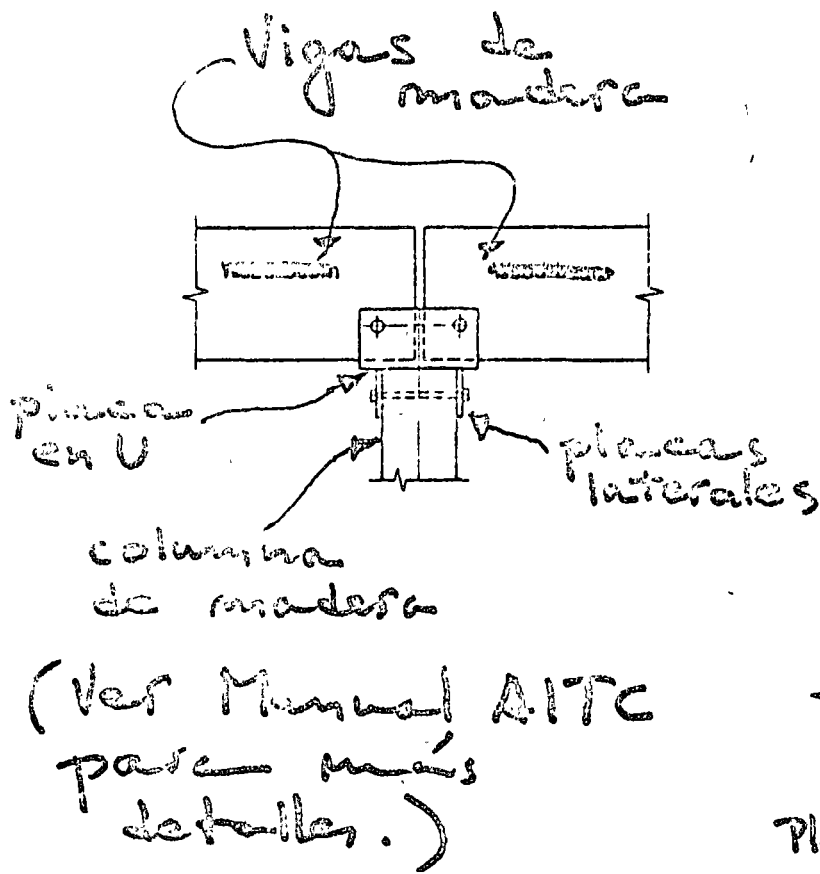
CONEXIONES ENTRE COLUMNAS Y VIGAS
